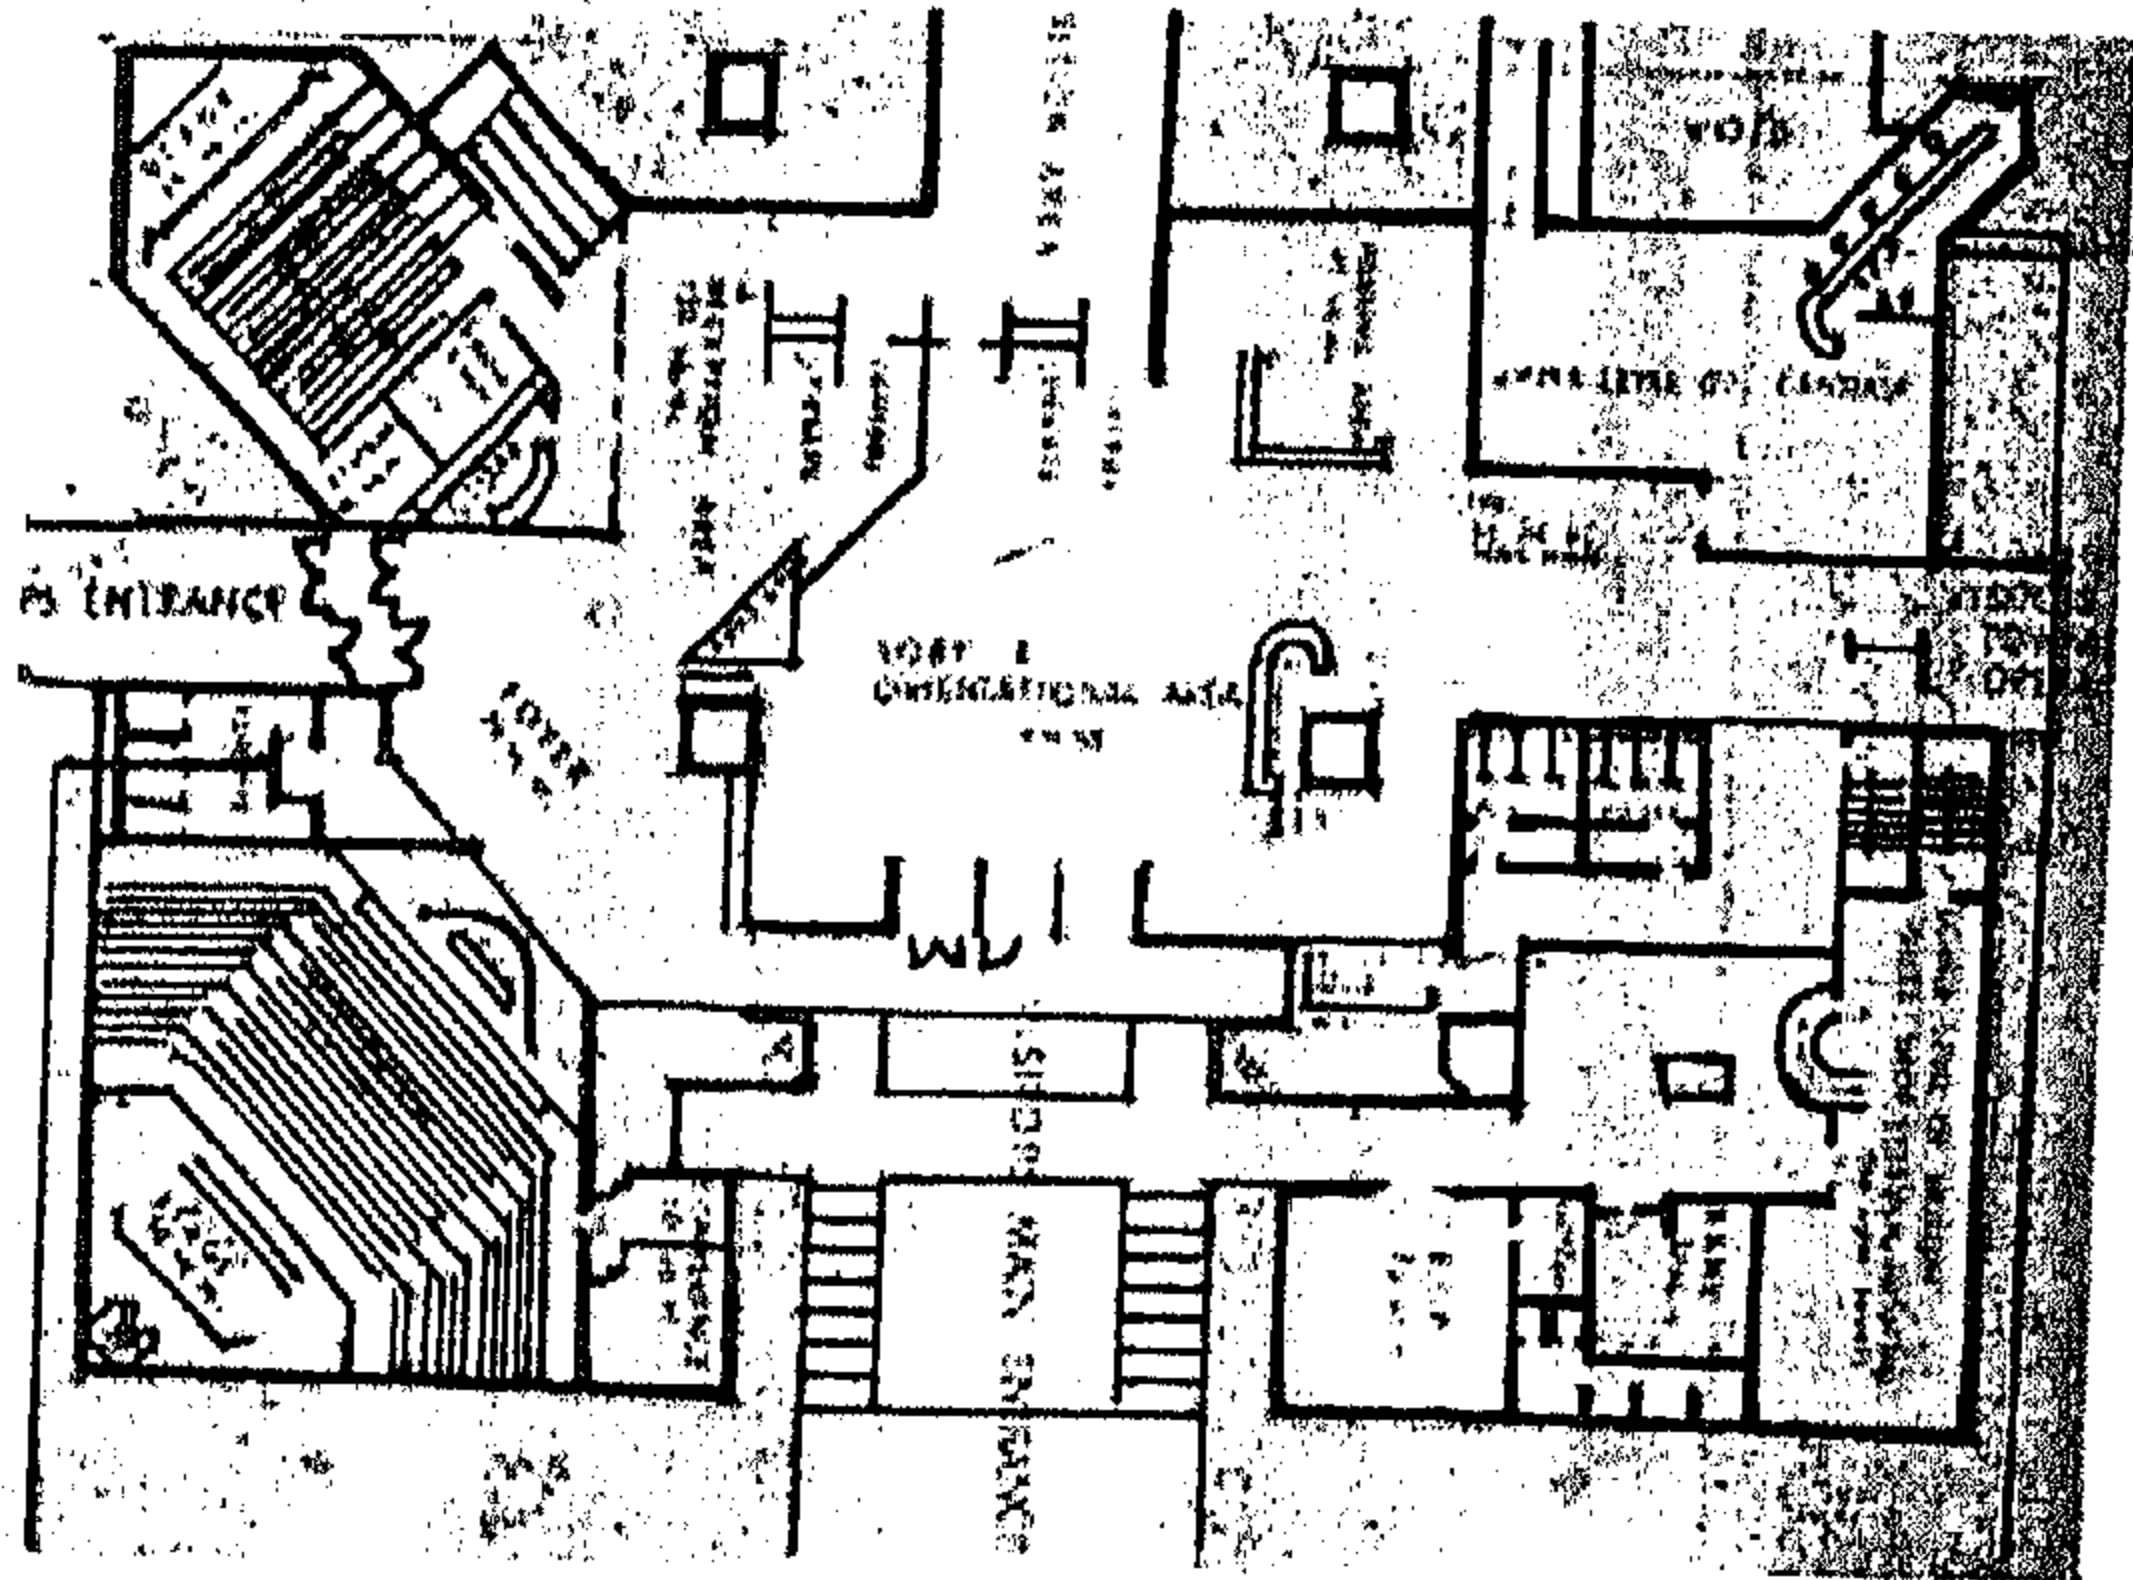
مسقط أفقي عام للموقع يوضح المباني القائمة
